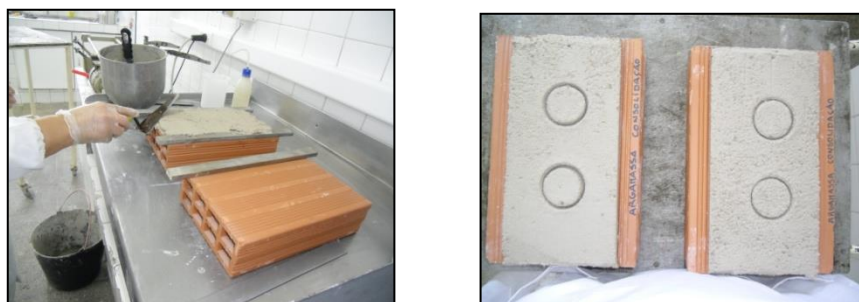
Aplicação da argamassa sob suporte de tijolo.
